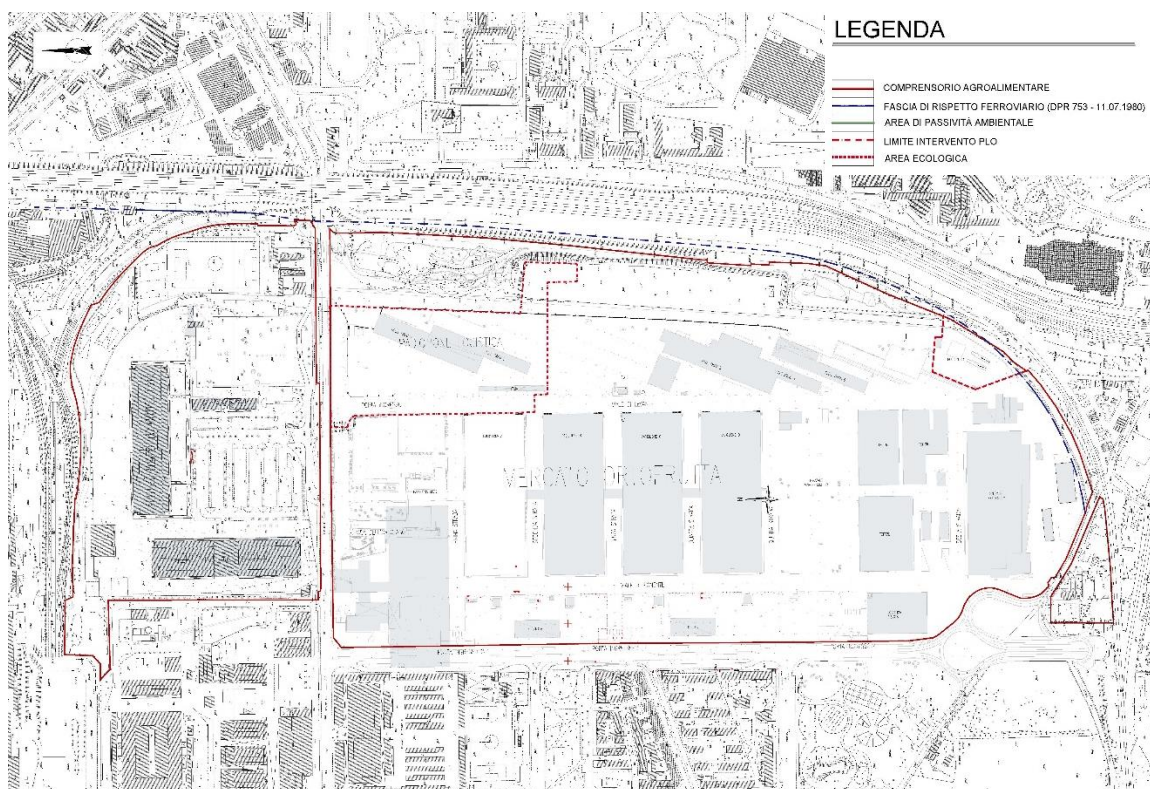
Planimetria generale dello stato di fatto con indicato il limite d'intervento
